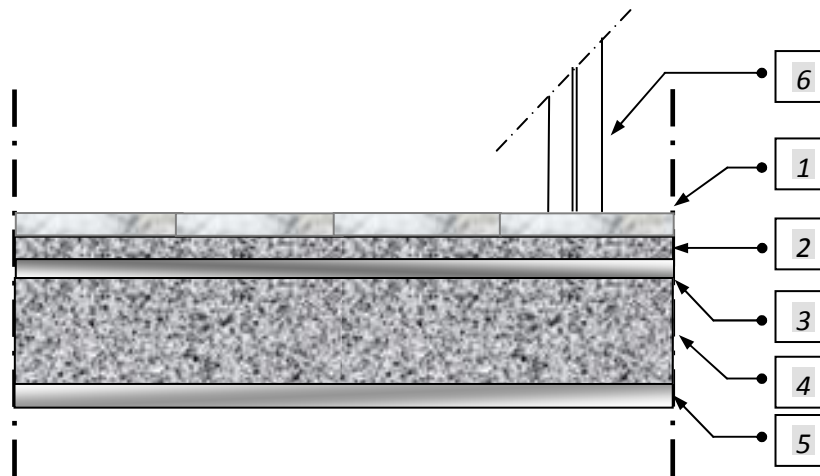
Coupe verticale du plancher courant à dalle pleine
